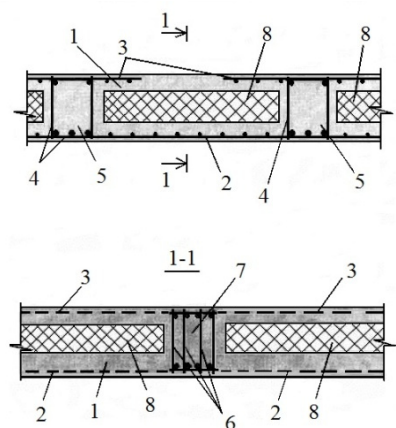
Конструкция облегченного железобетонного перекрытия с формой вкладыша параллелепипед: 1 – балочная плита; 2, 3 – арматура нижней и верхней сеток; 4 – арматурный каркас второстепенной балки; 5 – второстепенная балка; 6 – арматурный каркас главной балки; 7 – главная балка; 8 – вкладыш
